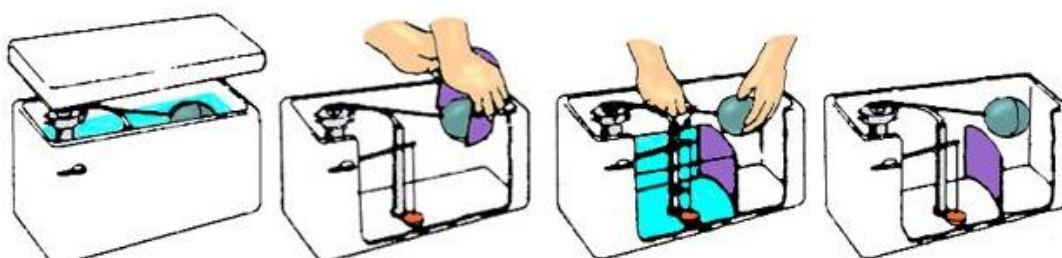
Instalação de barragem plástica (Águas do Algarve, 2010)
